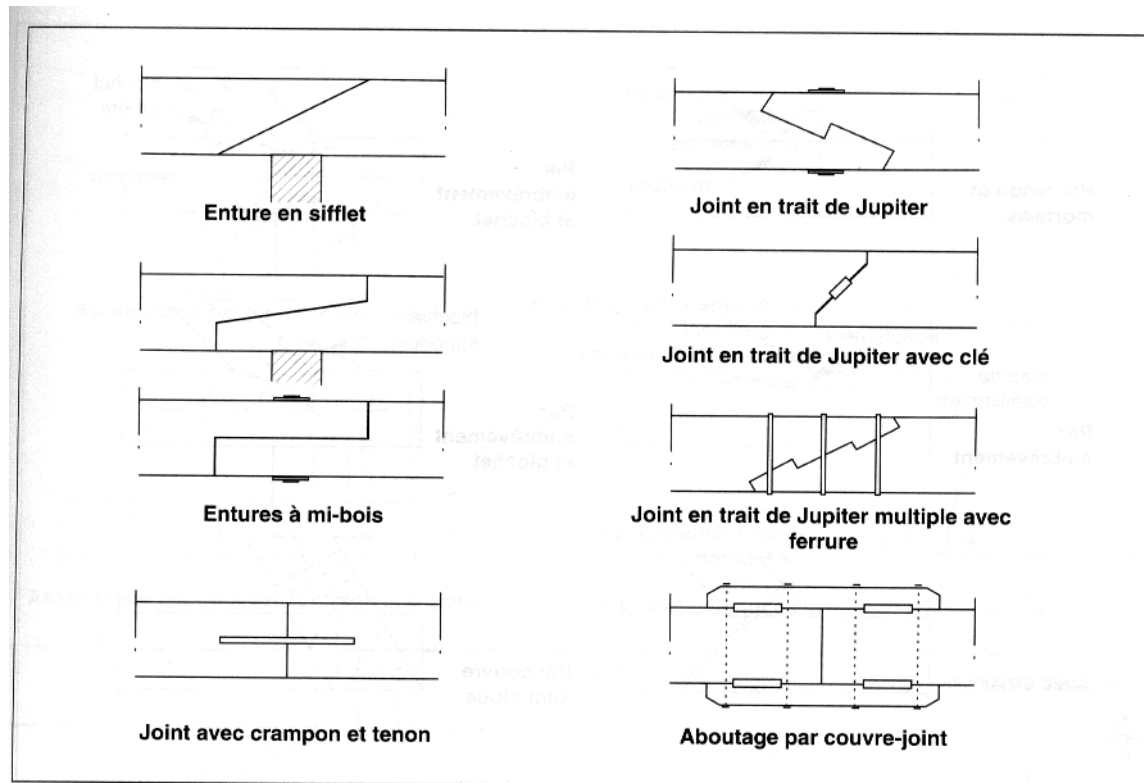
• Assemblages bout à bout (pièces horizontales ou faiblement inclinées)
